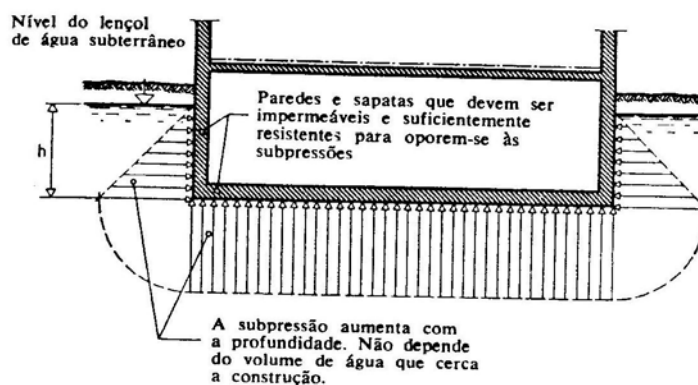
“Caixão” com paredes e laje de fundo impermeáveis.
